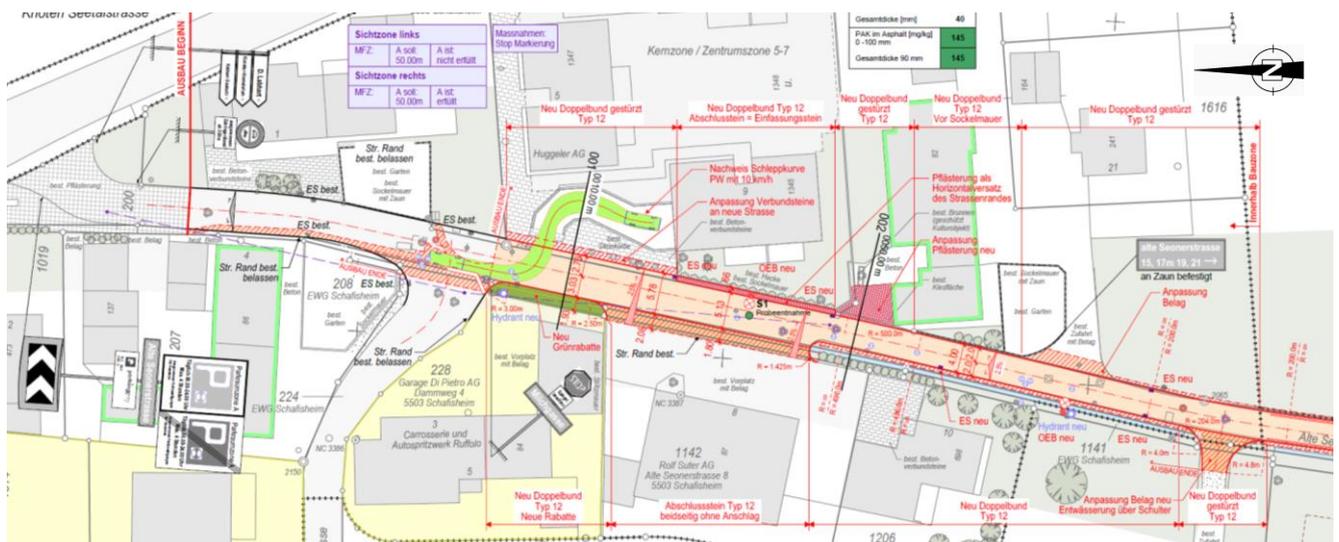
Planausschnitt aus dem Strassenbauplan – Bereich Milchgasse bis Ende beidseitiger Bauzone
